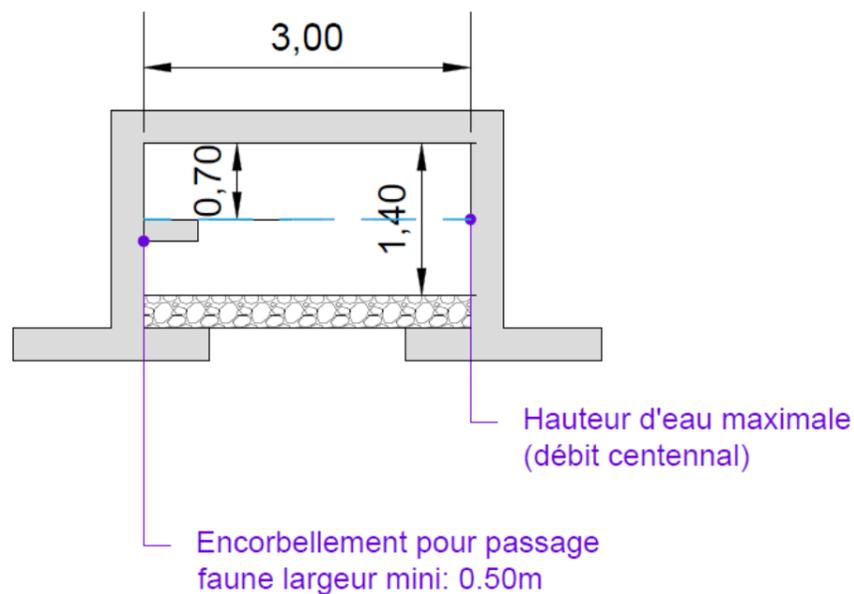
Profil en travers de l'ouvrage de transparence hydraulique (Source : Notice d'assainissement)
